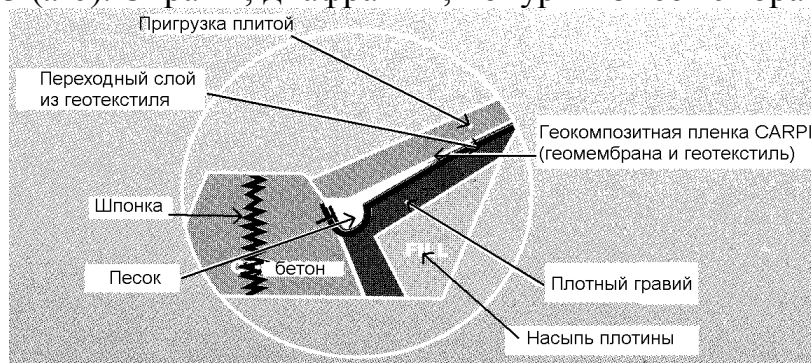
Узел сопряжения экрана из геомембраны Carpi с бетонным упором в основании верхового откоса земляной плотины
